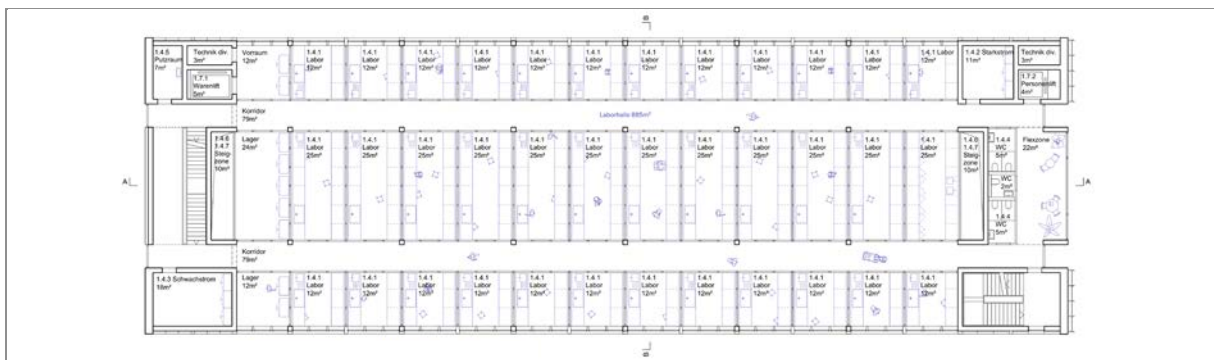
Grundriss Erdgeschoss
